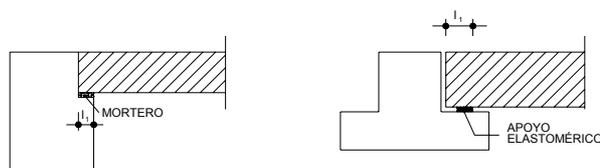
a Apoyos directos de losas alveolares
